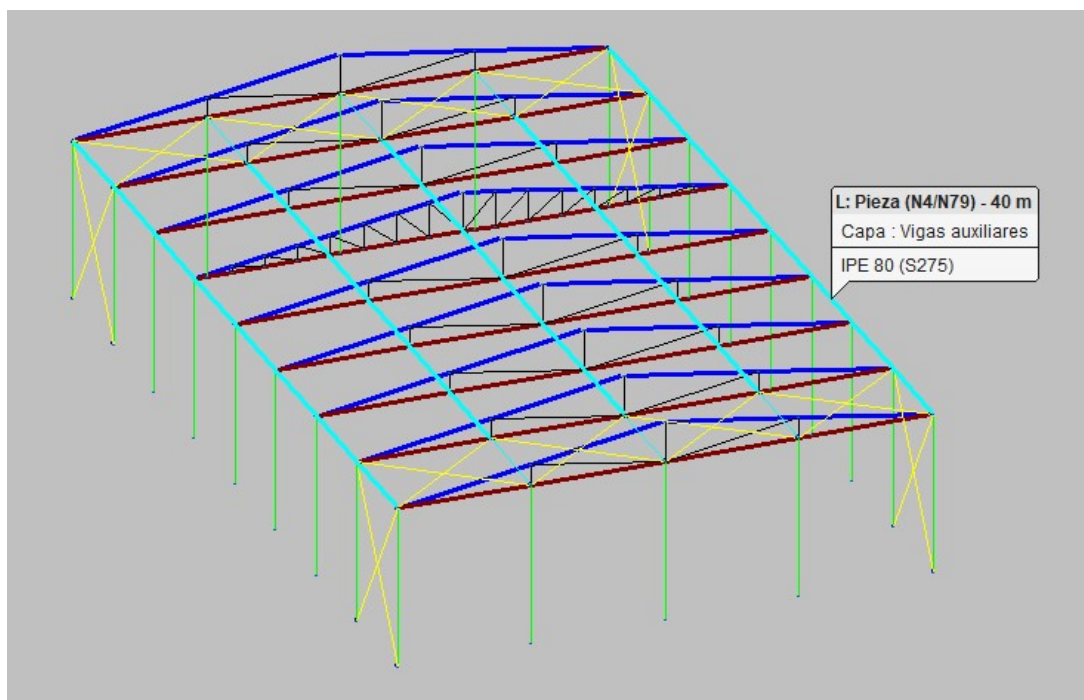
“Pórtico Celosía Americana 8 vanos. Detalle de Vigas auxiliares. CYPE 3D.
